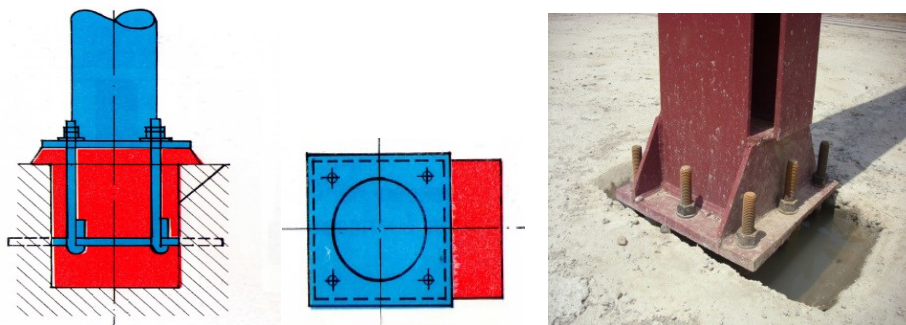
encastremets de poteau tubulaire et en croisillon par rapport aux deux axes principaux
